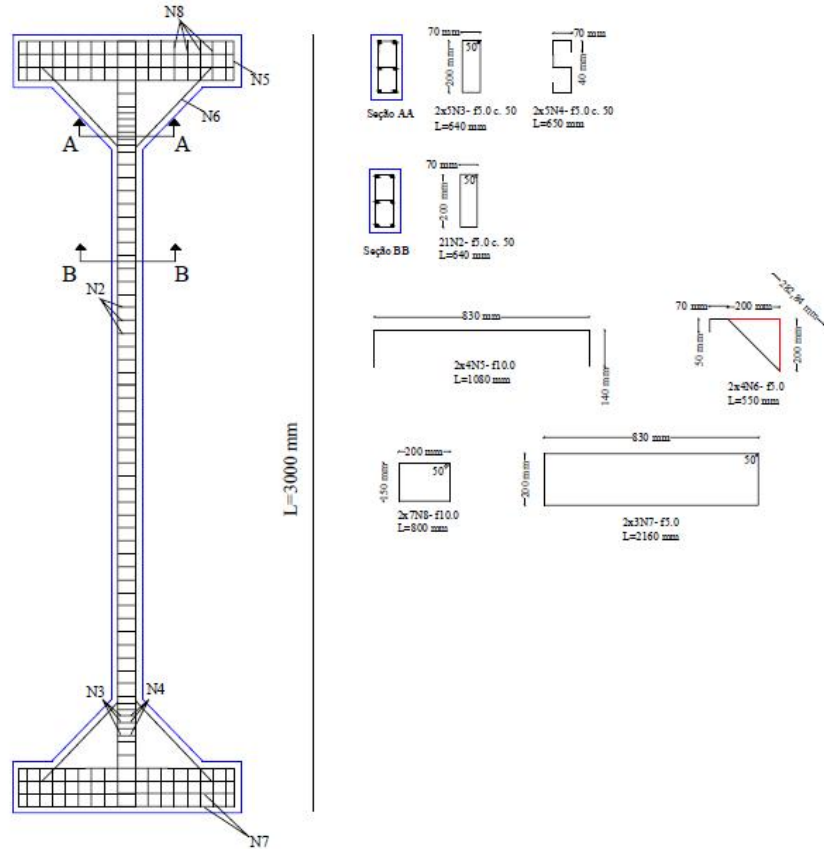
Detalhamento das armaduras – DANTAS (2006)
